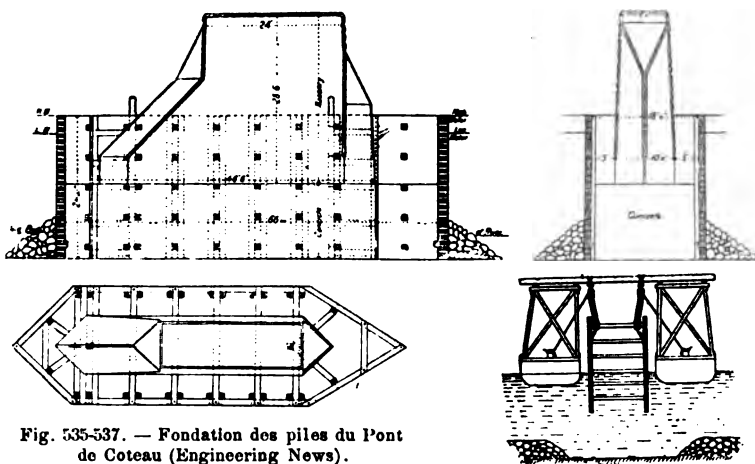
Fondation des piles du Pont de Coteau (Engineering News).
